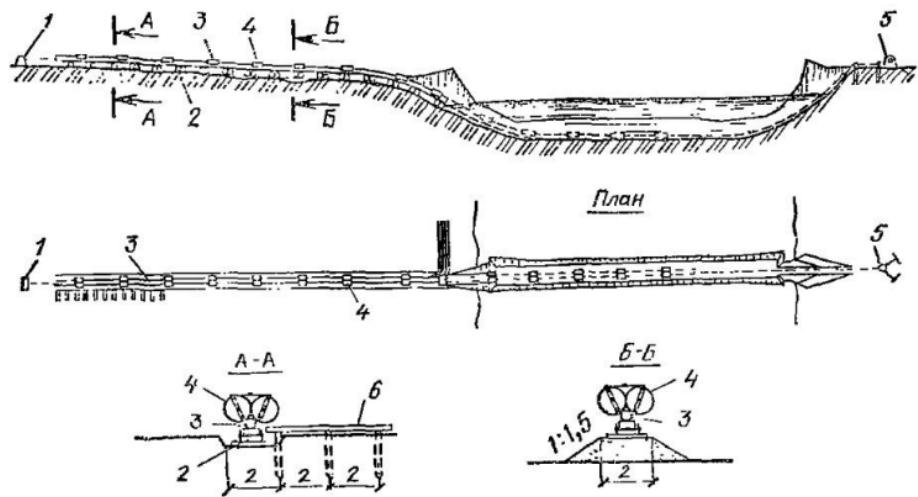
Схема укладки трубопровода способом протаскивания по дну водоема
